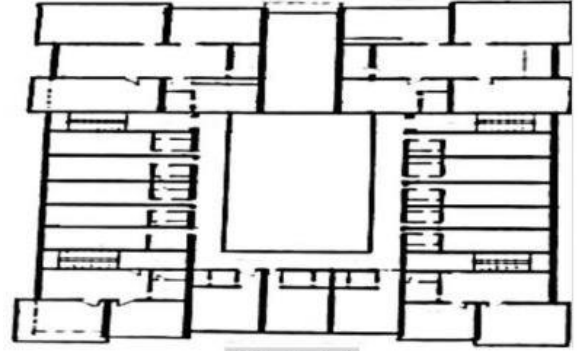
خان داود باشا برشيد: مسقط أفقي للطابق الأرضي نقلاً عن الحلوجي، محمد، دراسات في وكالات رشيد المندثرة من واقع الوثائق
